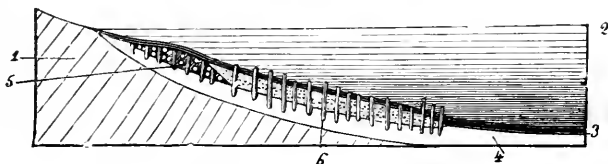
Coupe d'une construction sur pilotis dans les lacs.
